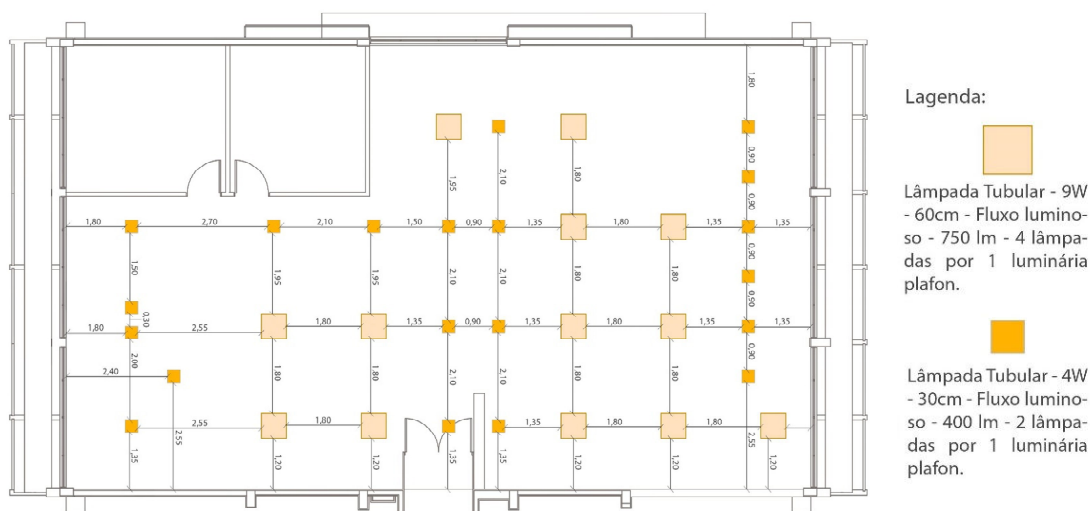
Planta de forro. Fonte: elaborado pelos autores.
